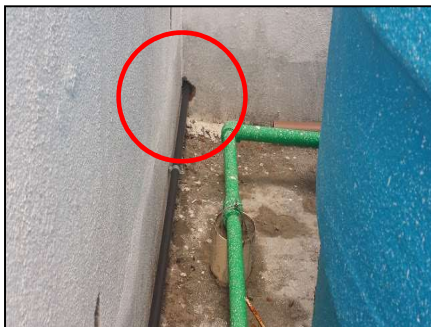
Impermeabilização perfurada para a passagem de tubulação.
